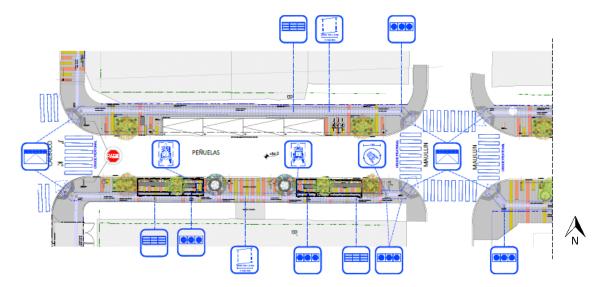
Plano de accesibilidad universal/ Guixe Arquitectos Spa.
